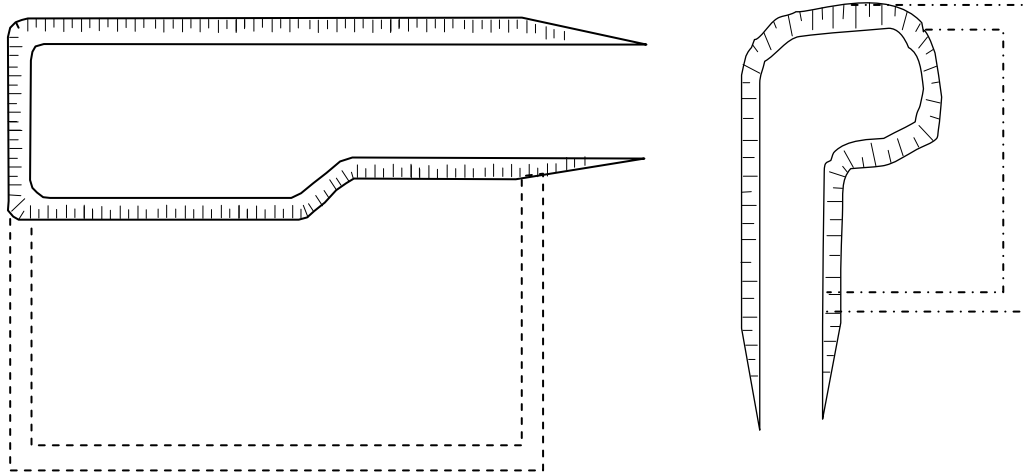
Vista en planta y perfil de apertura con trincheras sucesivas .
